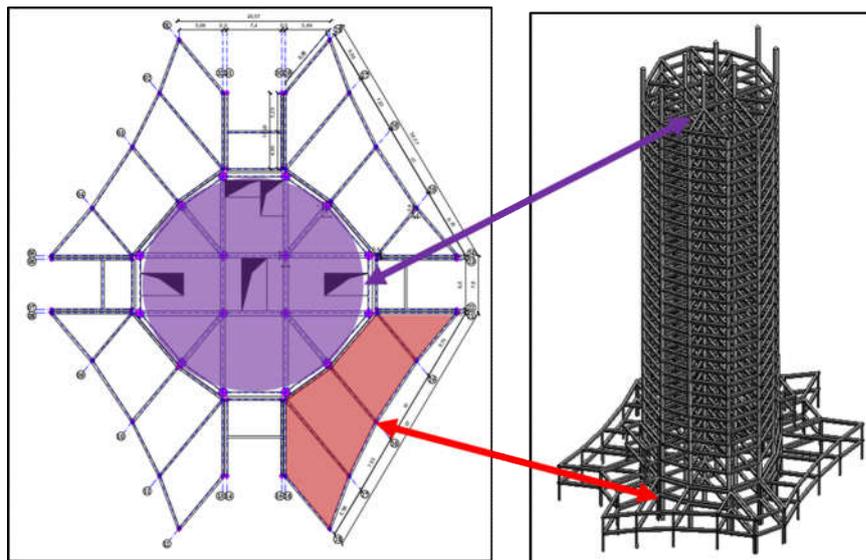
Plan et 3D de structure du projet. Source : les auteurs
